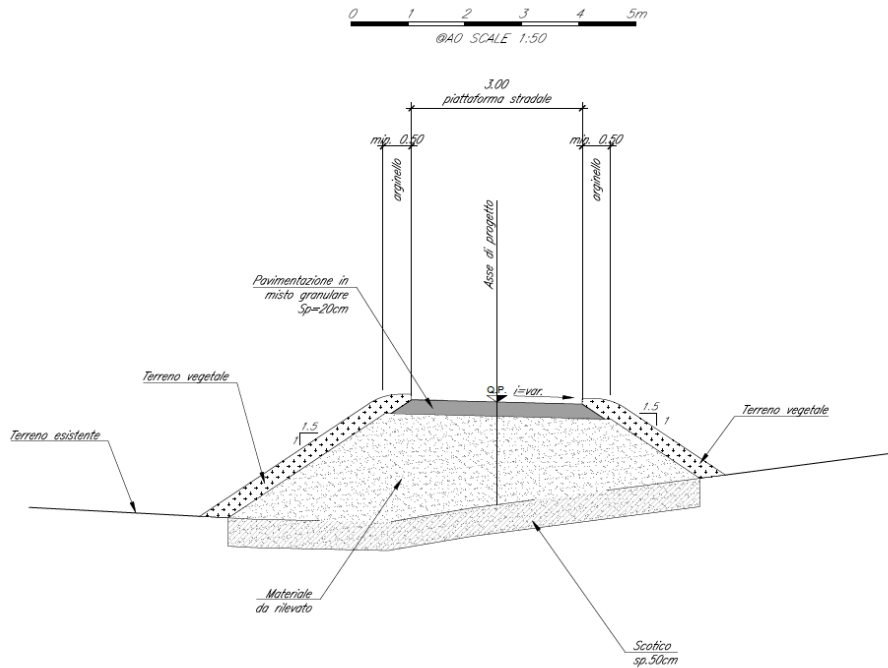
Sezione tipo NV11-Asse 4 in rilevato
